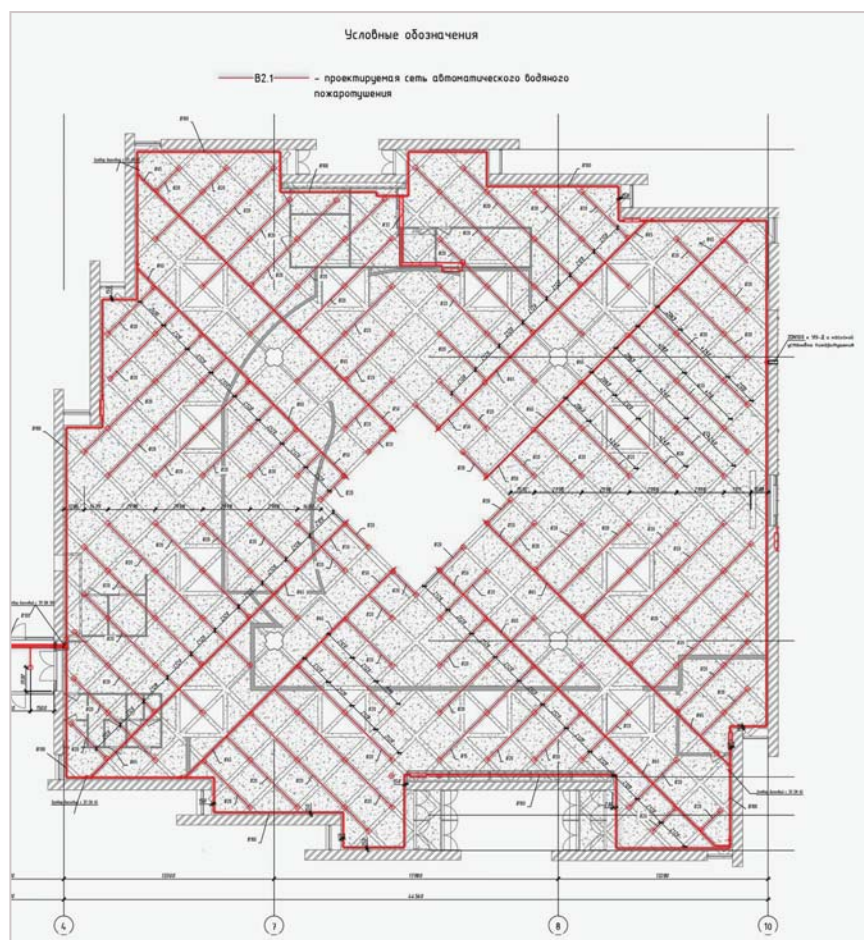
Фрагмент плана 1-го этажа с трубопроводной разводкой АУП-ТРВ по балкам кессонированного потолка
